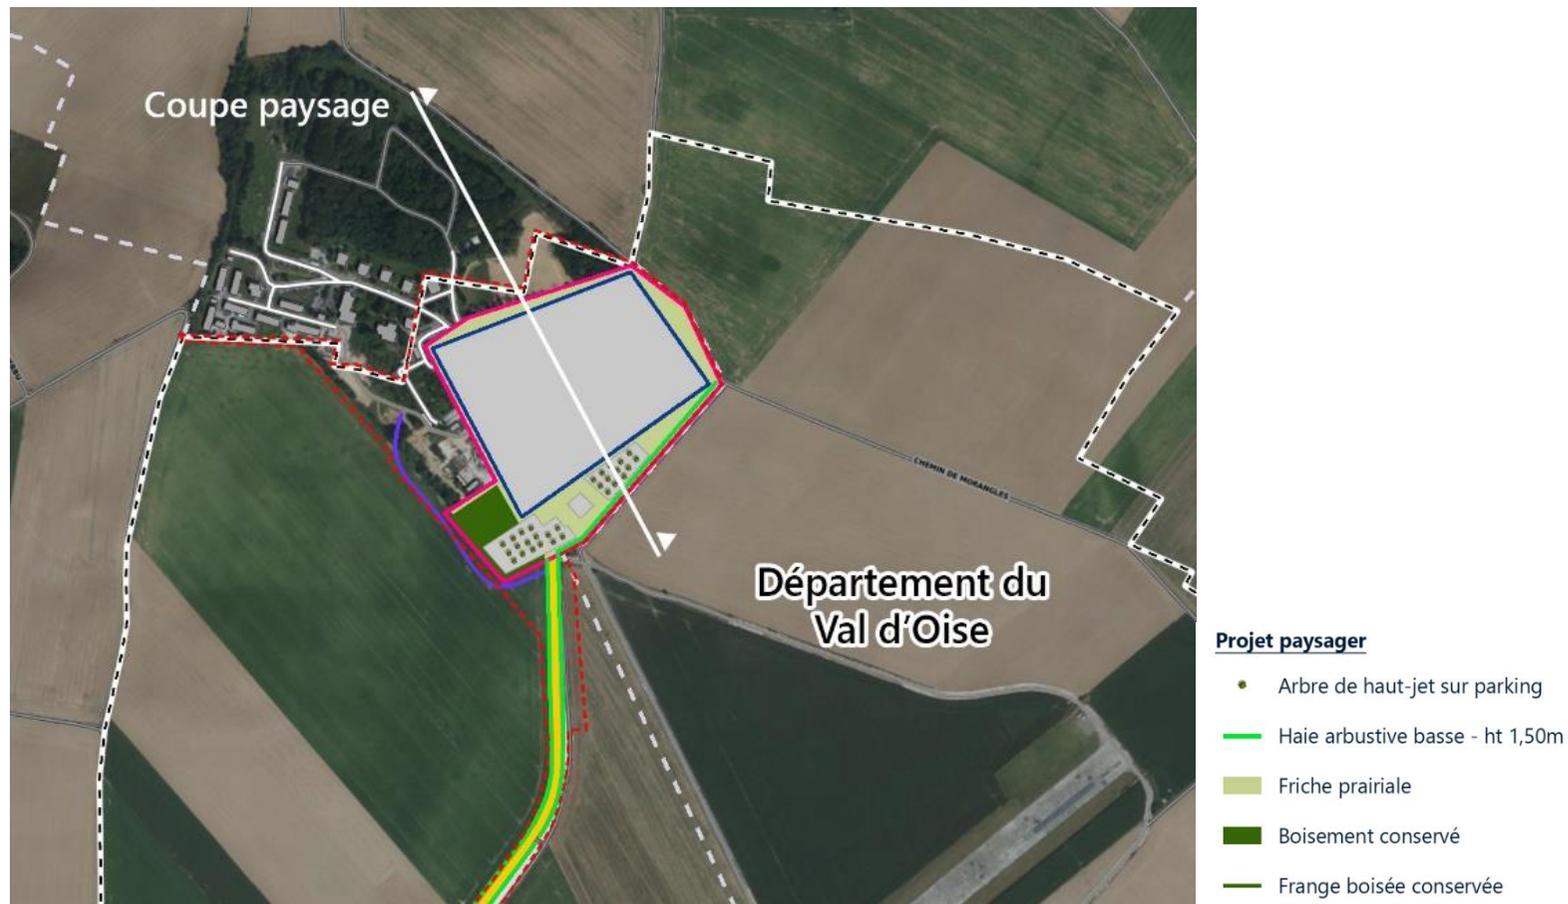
Proposition de plan de masse paysager (issu d'une étude de faisabilité)
